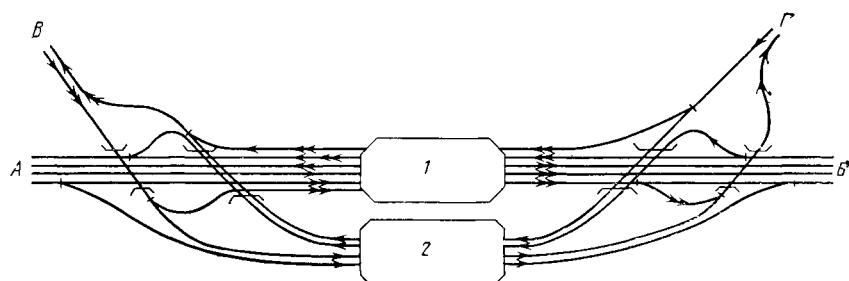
Схема пассажирской станции сквозного типа с внешним расположением путей для пропуска грузовых поездов:
